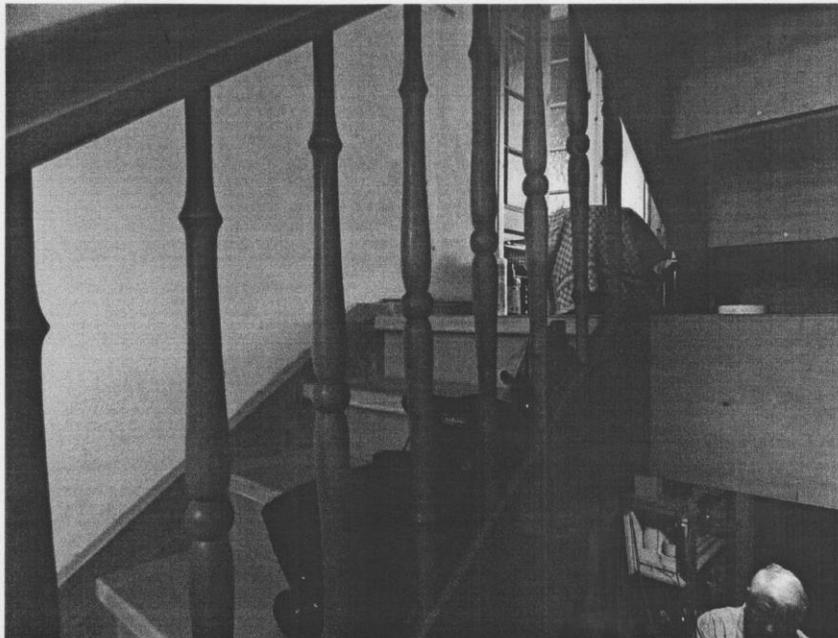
Treppenanlage auf Niveau der Erdgeschossdecke
